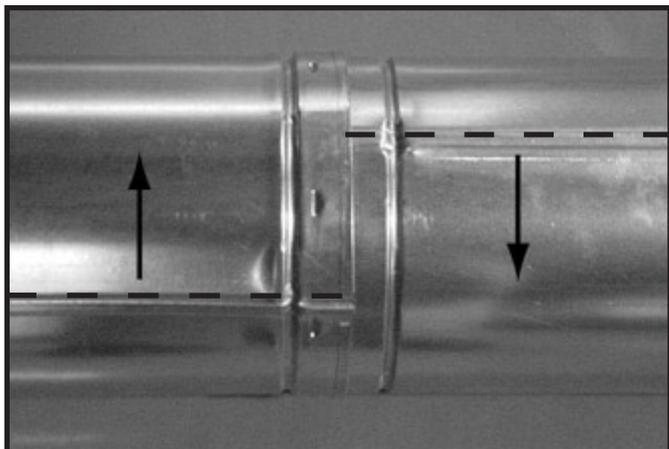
Faire tourner les joints d'assemblage pour le démontage
